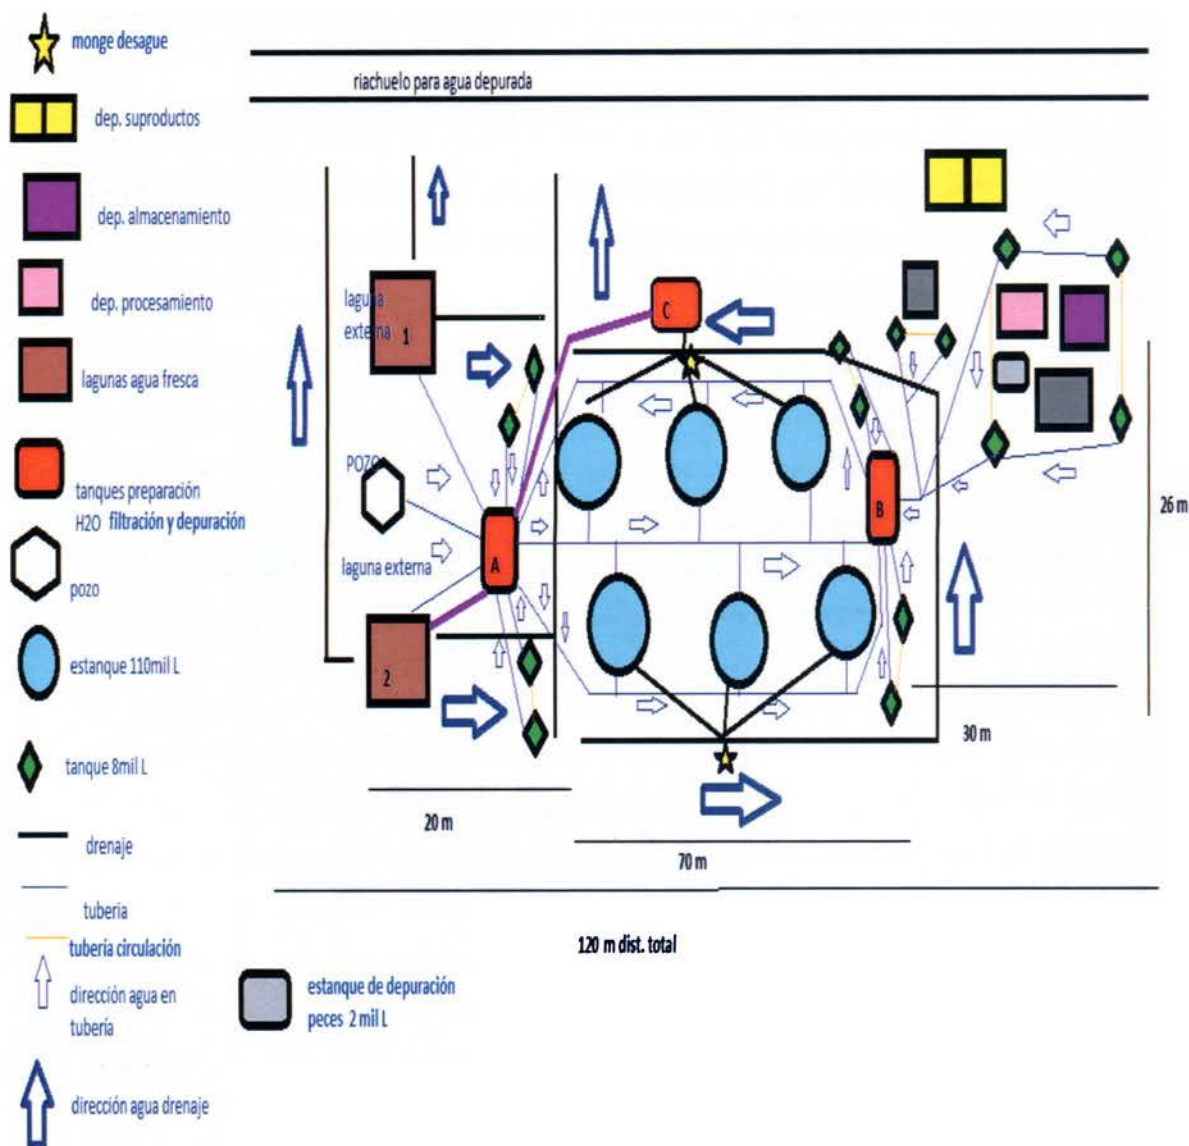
Plano real de la finca con imagen del croquis del proyecto
